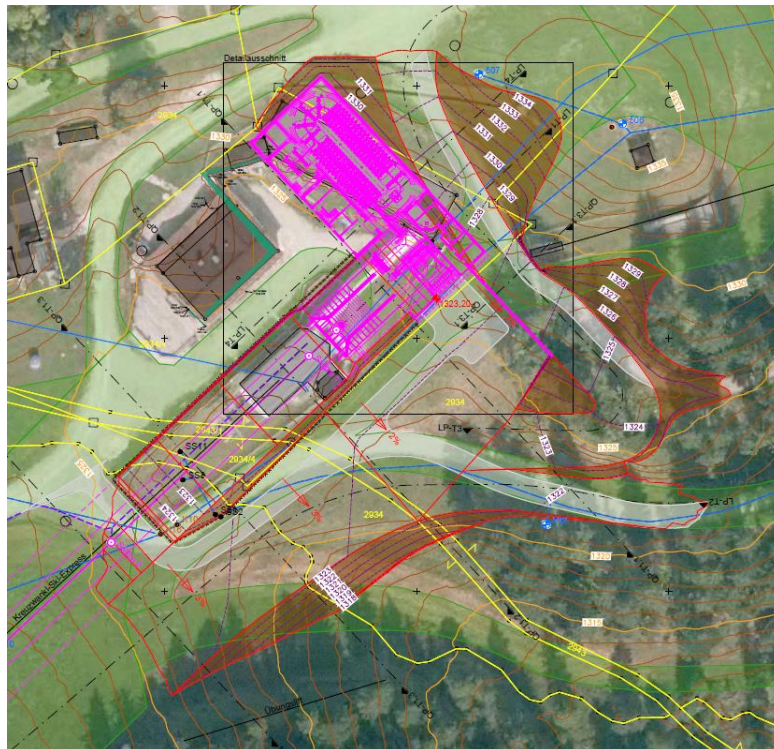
Detaillageplan Talstationsbereich Kreuzwankl.
